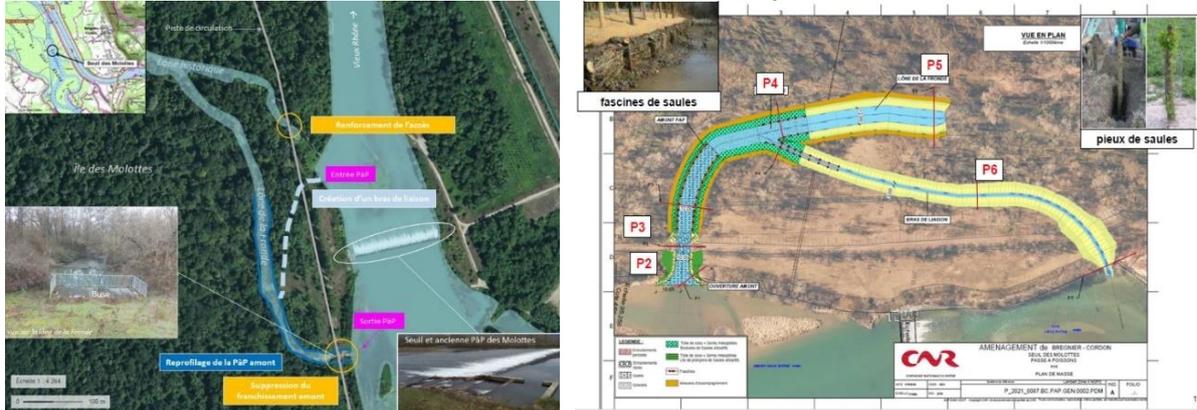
Contexte, principe et plan détaillé de l'ouvrage.
